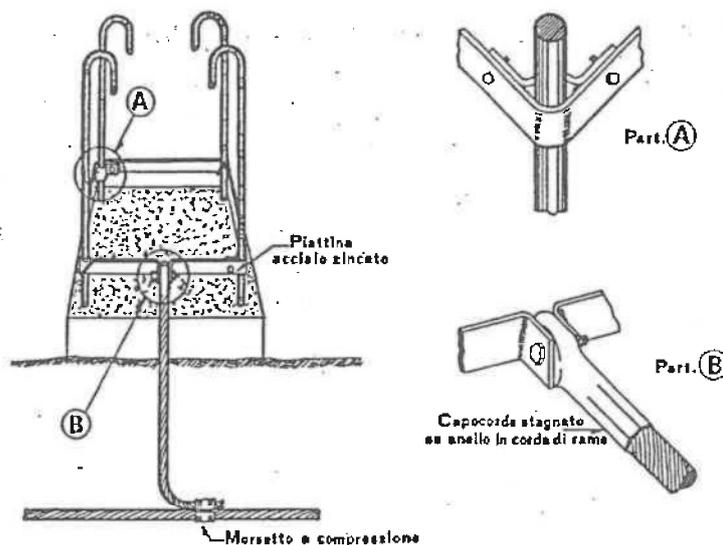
Collegamenti alle strutture metalliche di armatura
